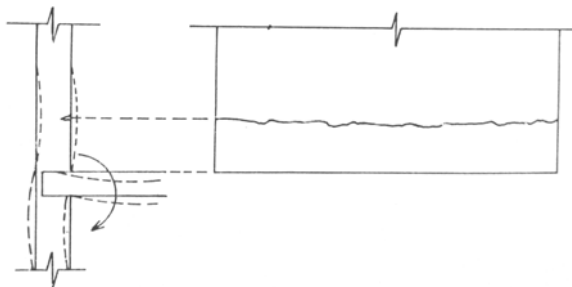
Trinca horizontal na base da parede provocada pela deformação excessiva da laje. (Fonte: THOMAZ)
